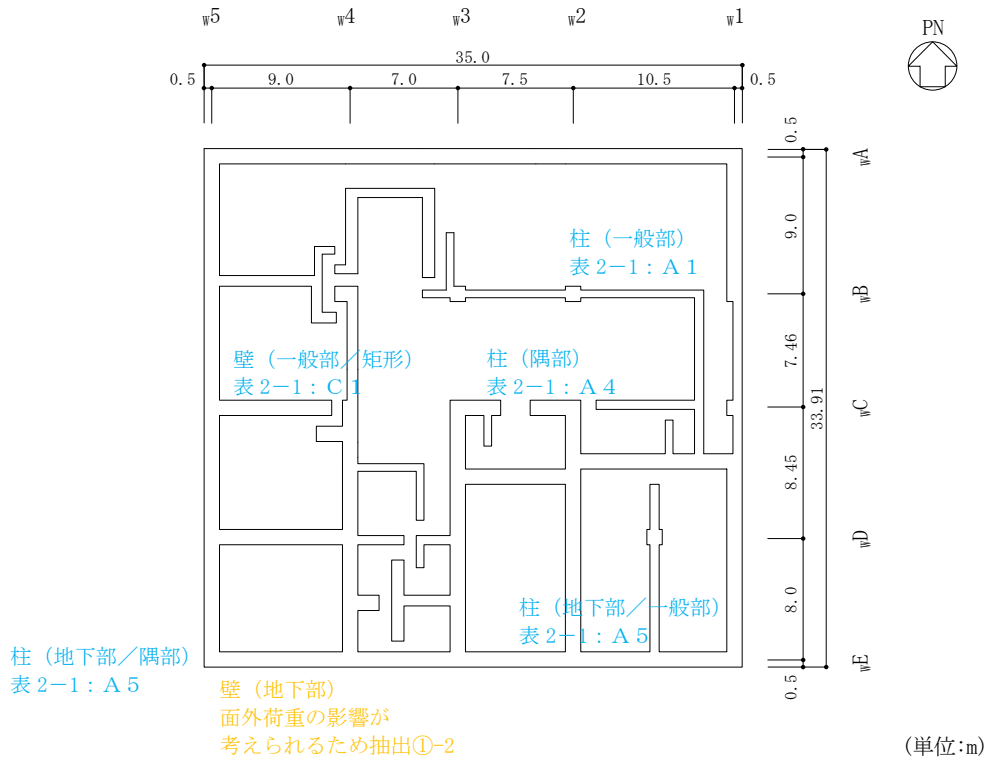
1号機廃棄物処理建物の概略平面図 (EL 6.5m)
